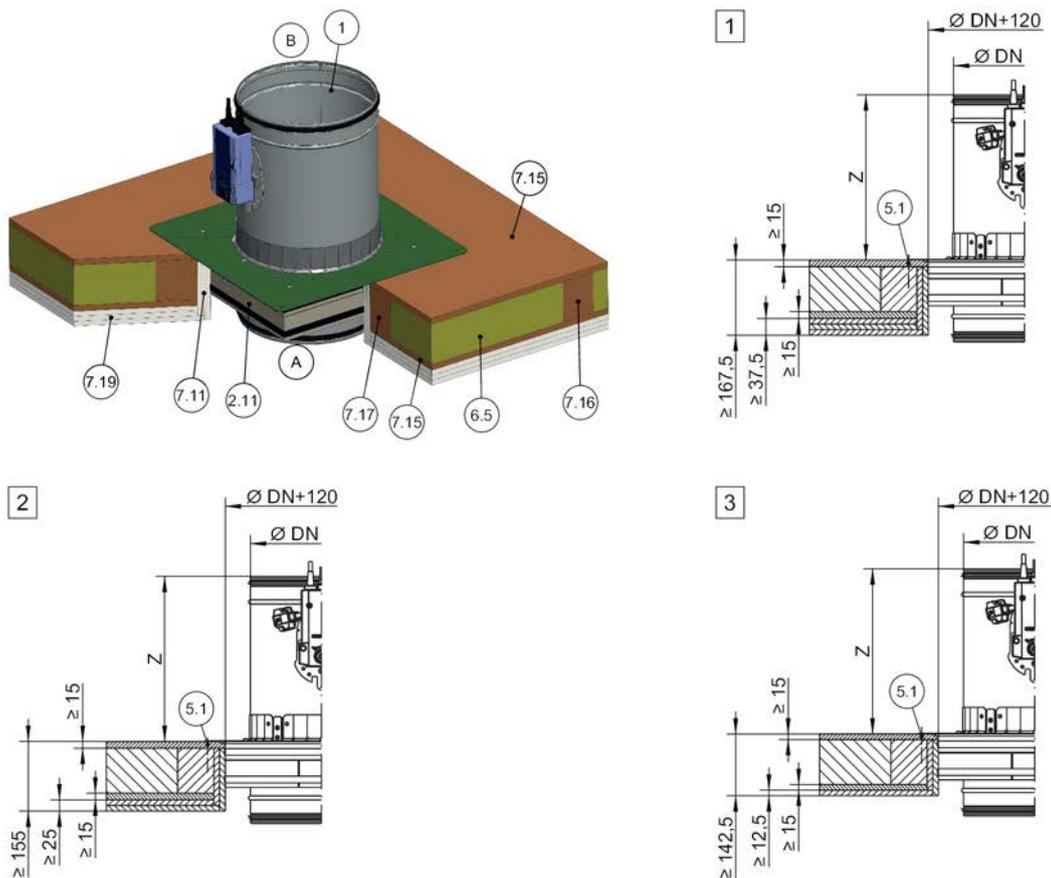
Montagem em argamassa em teto de vigas de madeira/de vigas laminadas, suspensa (ilustração representativa, estrutura de teto alternativa possível mediante pedido)
